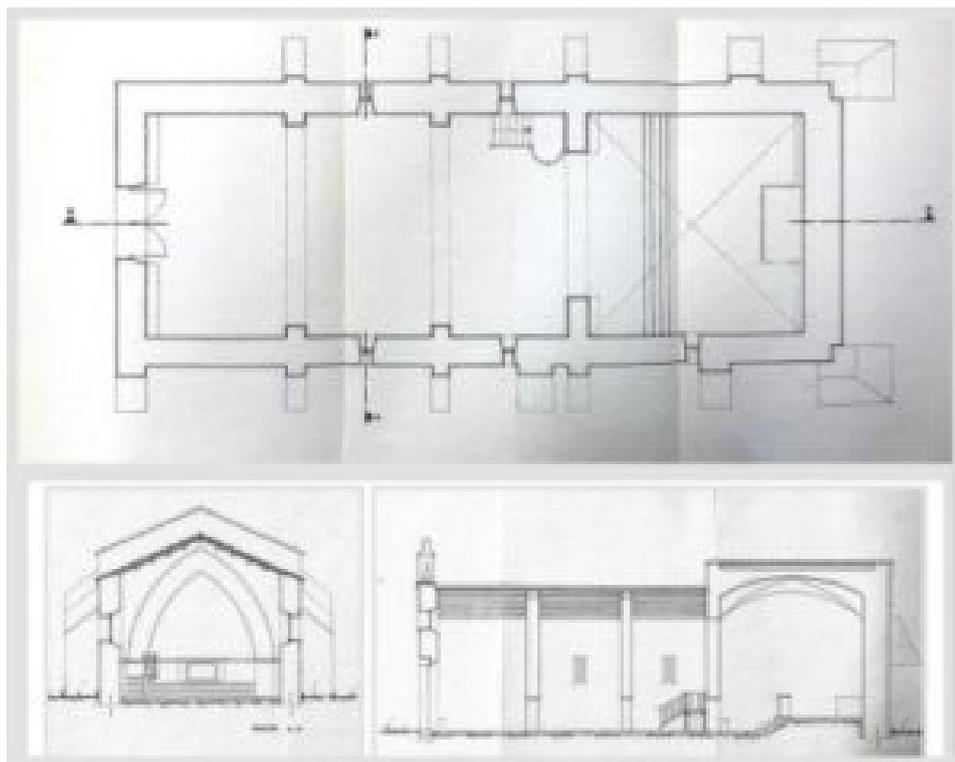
(a,b,c) Plano 3. Planta. Distribución antes de la reforma. Secciones.
